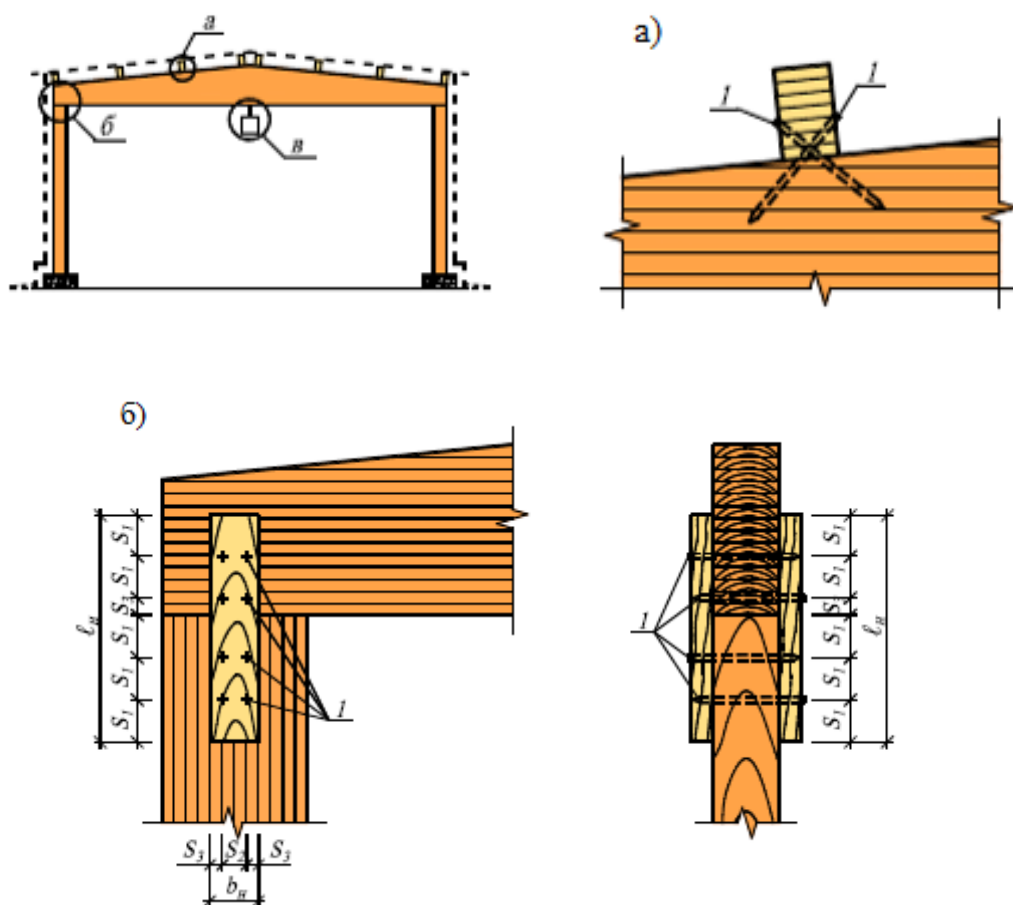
Простейшие узлы каркасного деревянного здания на витых стержнях крестообразного поперечного сечения: а) – крепление прогонов кровли; б) – сопряжение колонны и стропильной балки; 1 – витой стержень
